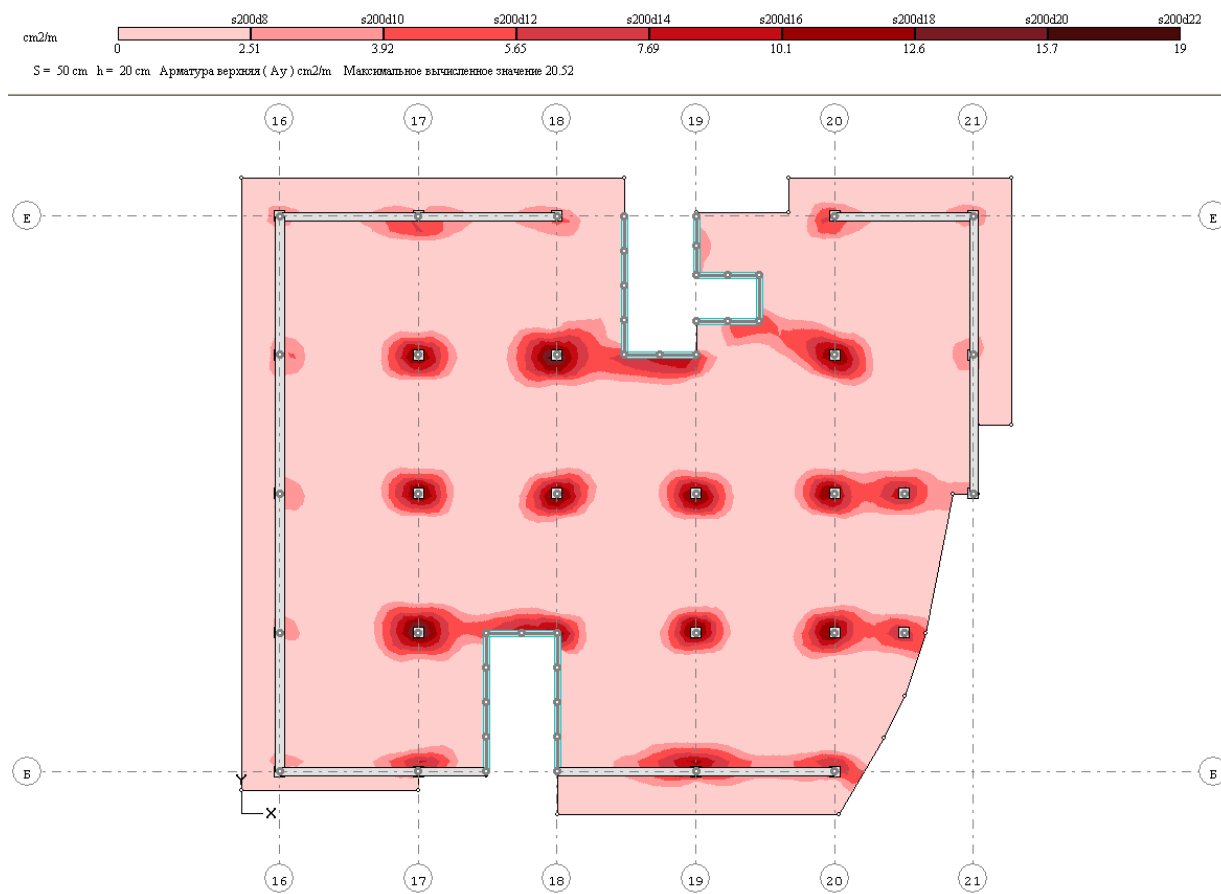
Схема верхнего армирования плиты перекрытия по оси OY
